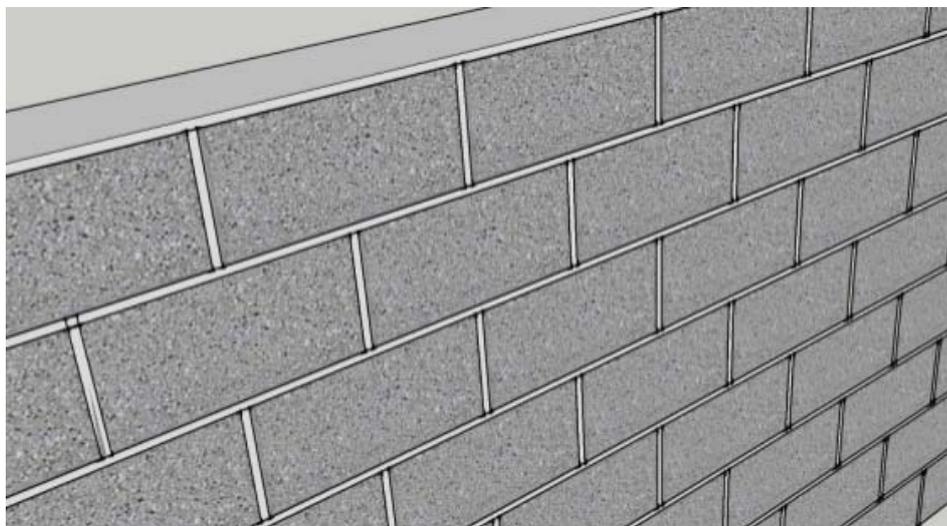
Juntas verticais e horizontais de 1 cm.
